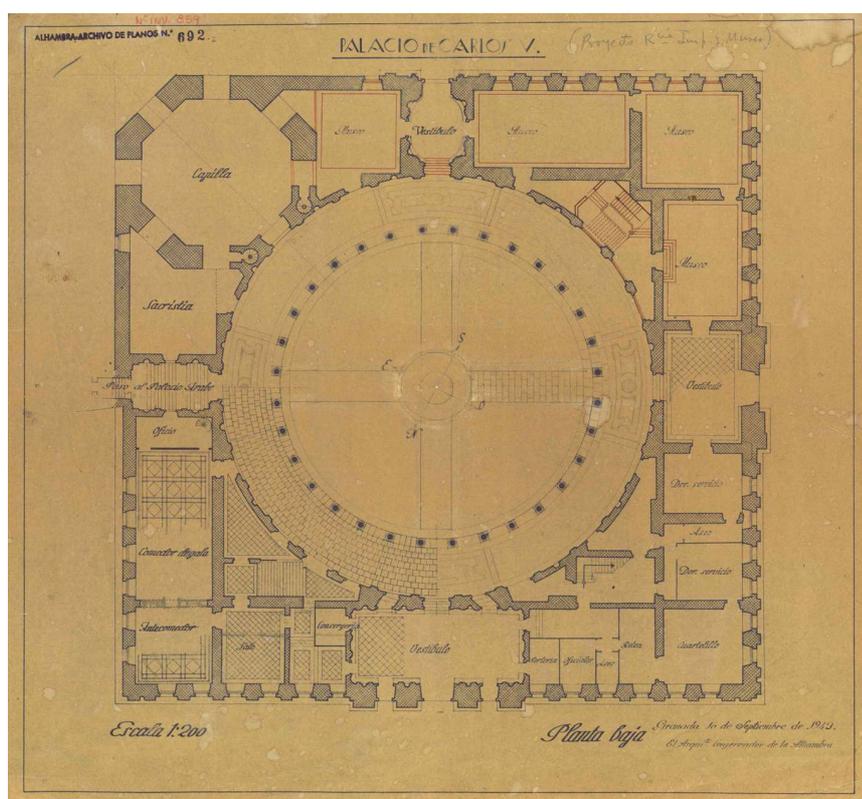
planta del Palacio de Carlos V, APAG / colección planos / P. 859.
